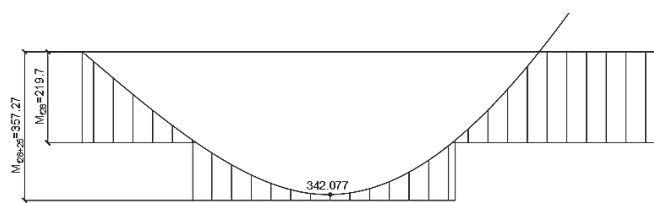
Эпюра материалов для арматуры в нижней зоне 1-го пролёта
